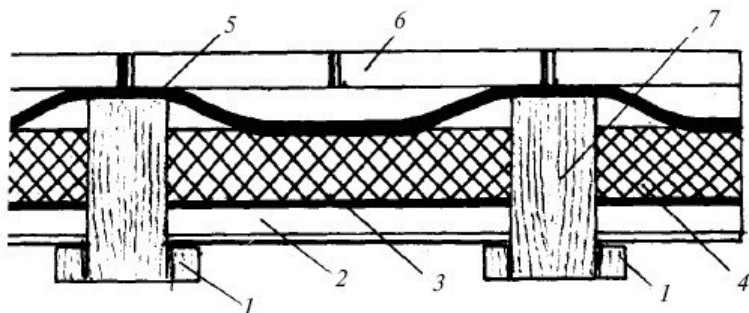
Теплоизоляция, уложенная на щиты, укрепленные по черепным брускам: 1 – черепной брусочек; 2 – щиты; 3 – гидроизоляция; 4 – теплоизоляция; 5 – пароизоляция; 6 – пол; 7 – лага
